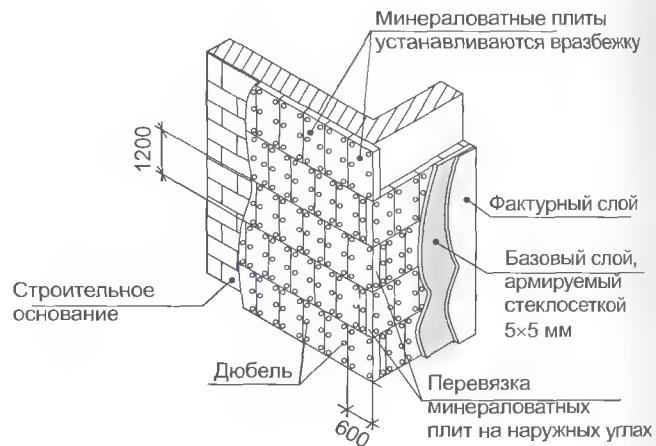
Система наружной теплоизоляции фасадов с применением в качестве утеплителя минераловатных плит «ЛАЭС-М»
